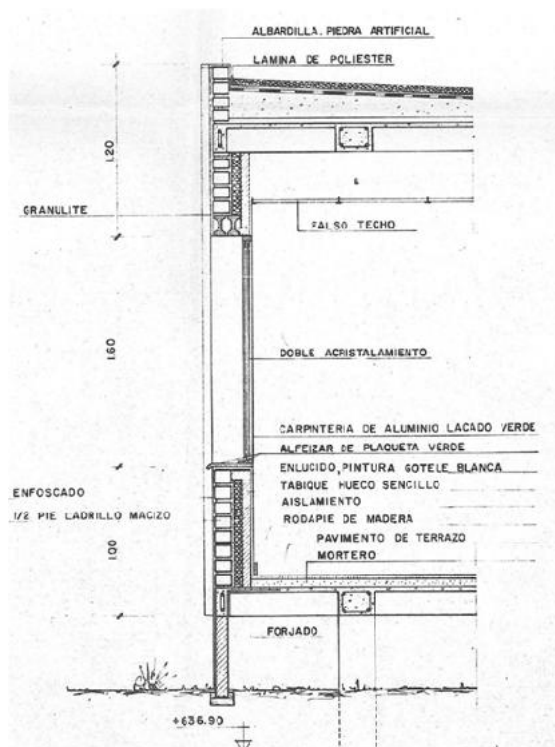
sección constructiva proyectada para el cerramiento exterior.
